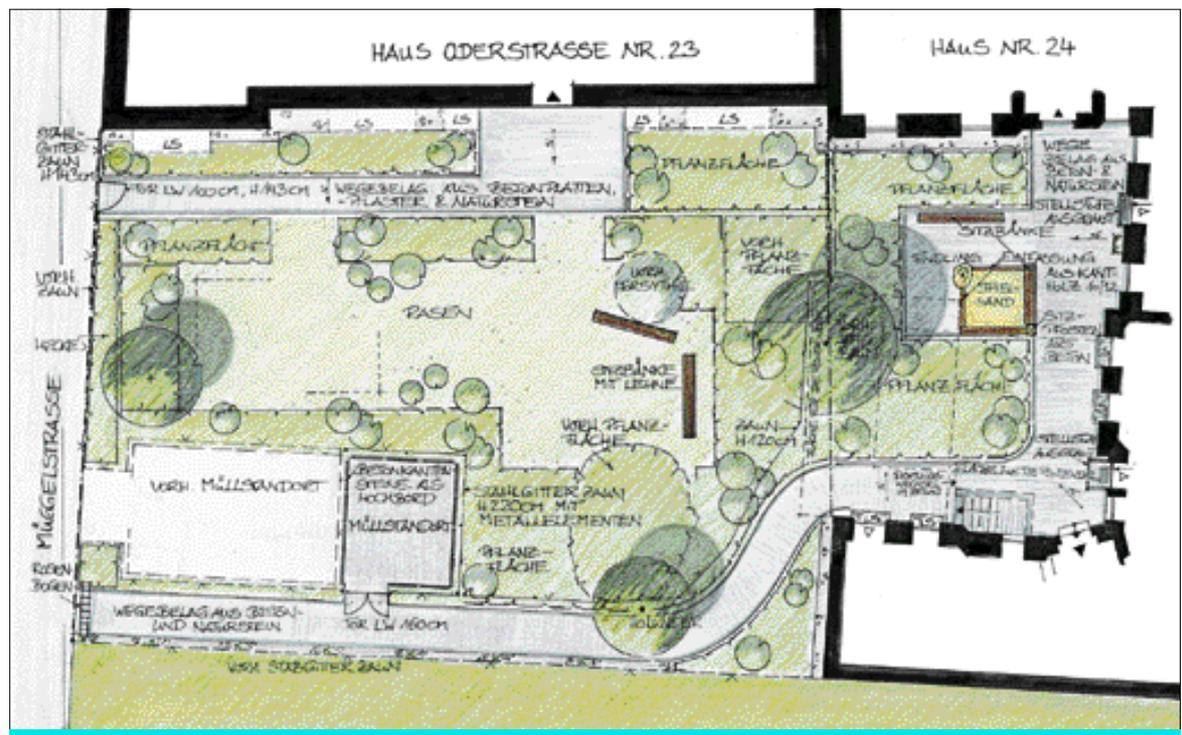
Projekt Oderstraße 24, Entwurf Außenanlagen
